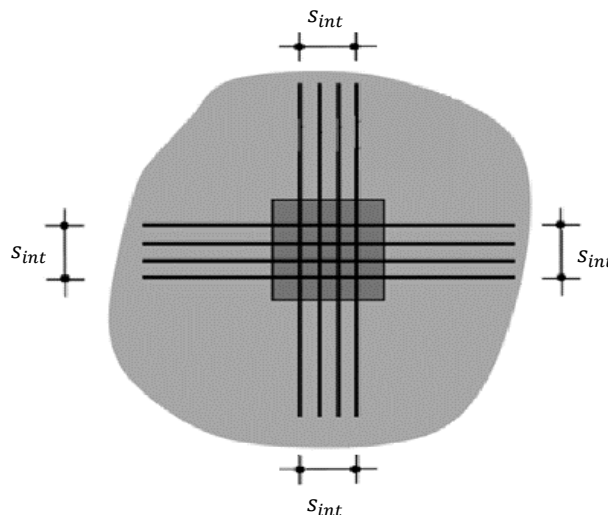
Disposição construtiva da armadura de suspensão (adaptado de [3])
